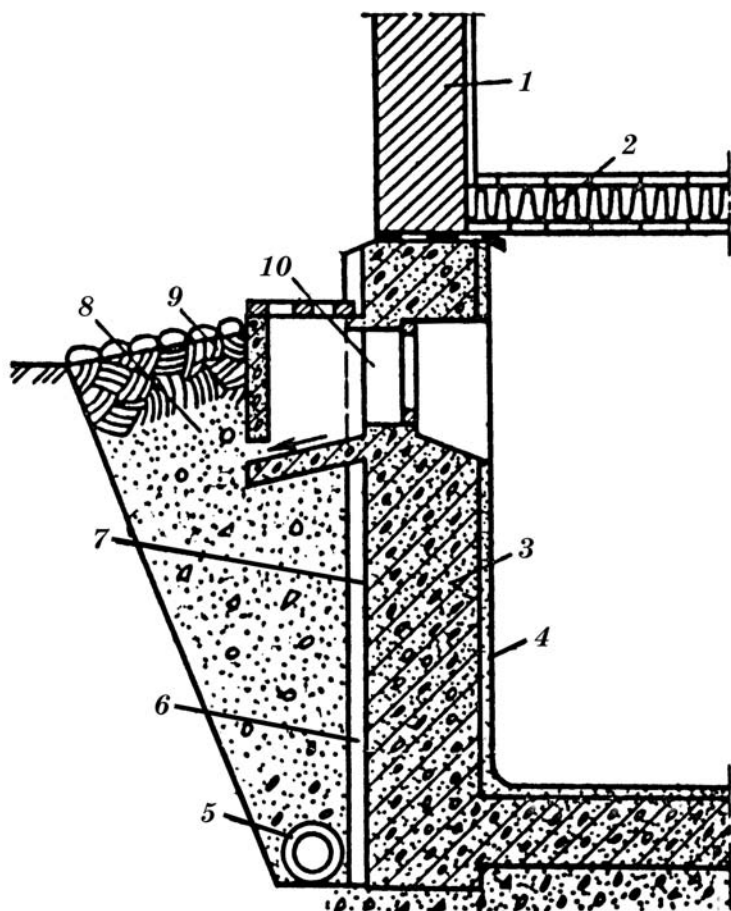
Общий вид конструкции подвала с закрытым дренажом: 1 – стена; 2 – пол; 3 – фундамент; 4 – отдельный слой штукатурки цементно-песчаного раствора; 5 – дренажная труба; 6 – гидроизоляция; 7 – слой цемента; 8 – грунт основания; 9 – отмостка; 10 – приямок.
